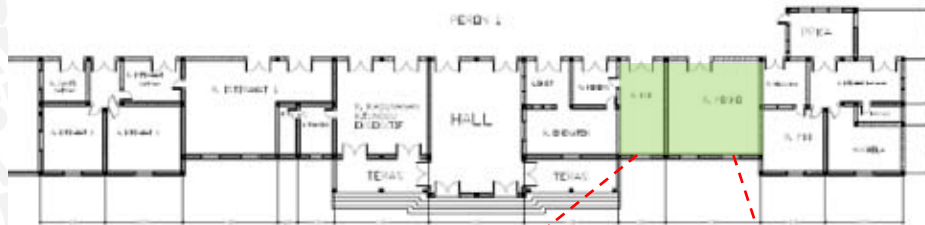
173 Kondisi eksisting jenis plafon tipe 5 pada ruang hall
